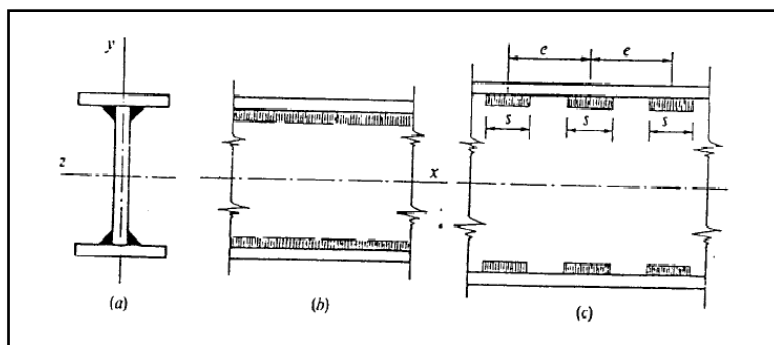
Nomenclatura soldadura discontinua.
